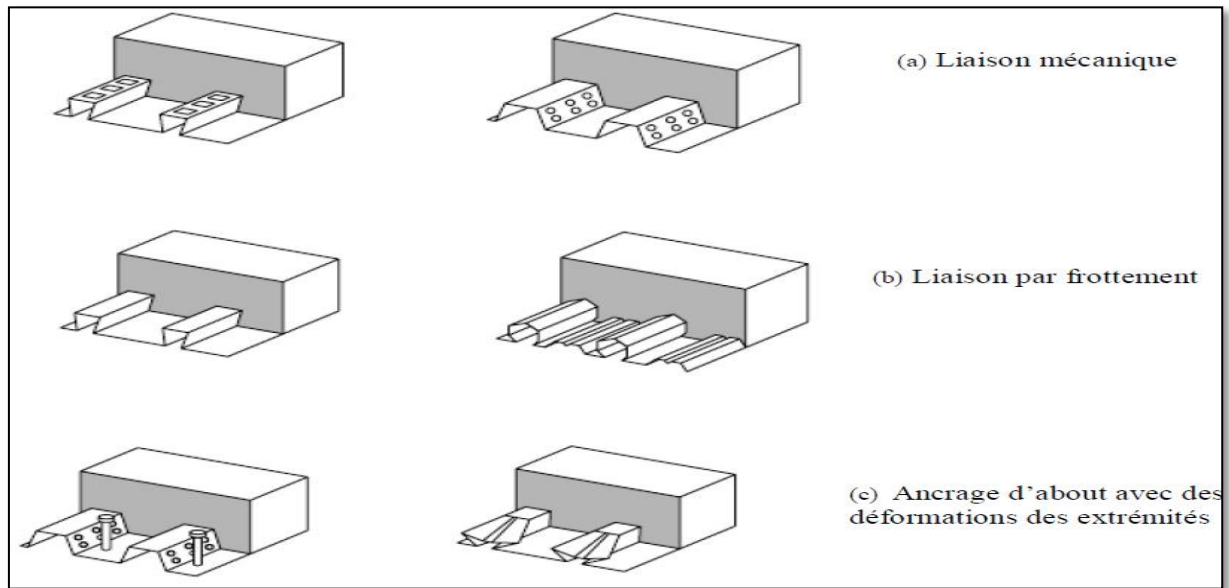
Les Dalles Mixtes (Source: Cours Mr Boukhelkhal)
